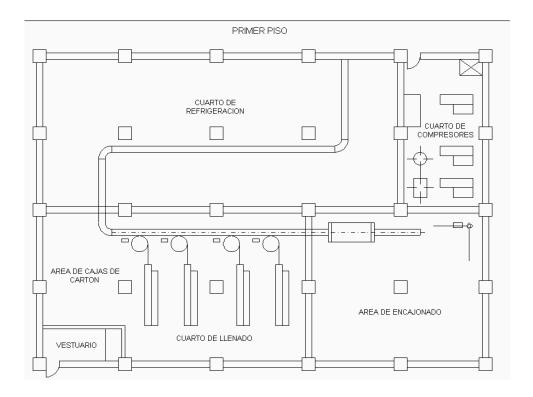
LAY OUT PLANTA DE BEBIDAS ÁREA DE LLENADO
